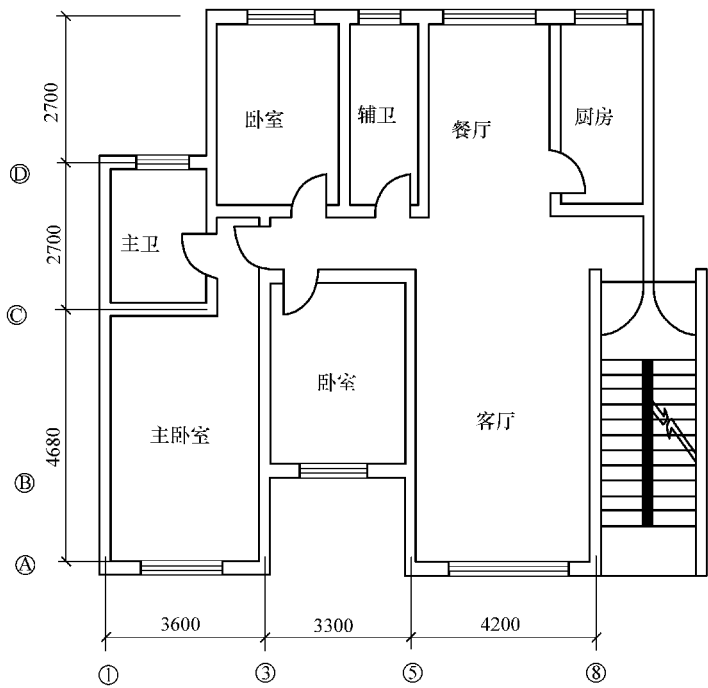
某住宅（3 室 2 厅 2 卫）平面图
